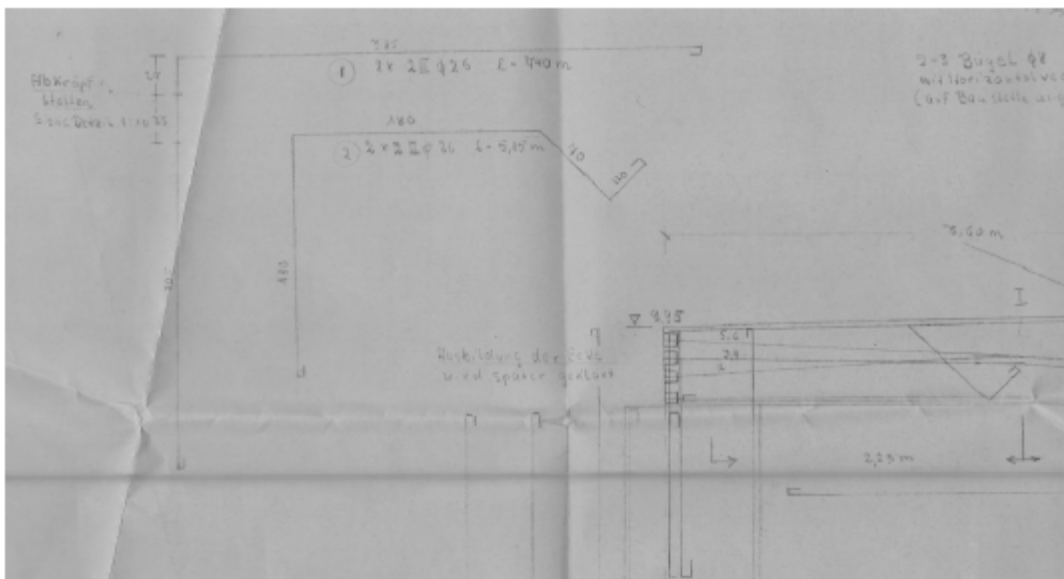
Bewehrungsführung Rahmenecke (Auszug aus Plan Spannbetonrahmen Plan Nr. D/GO/55/32)
